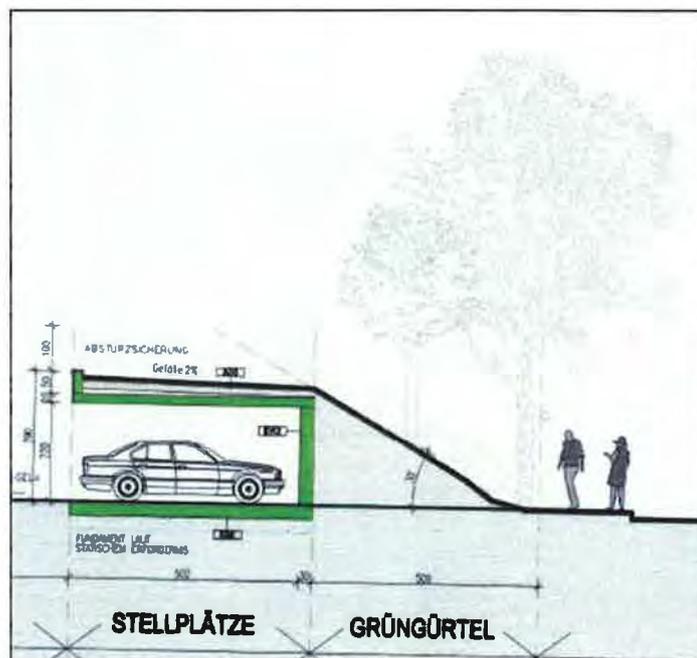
Unmaßstäblicher Ausschnitt aus den Projektunterlagen zu den teilweise bereits bestehenden Geschosswohnbauten
